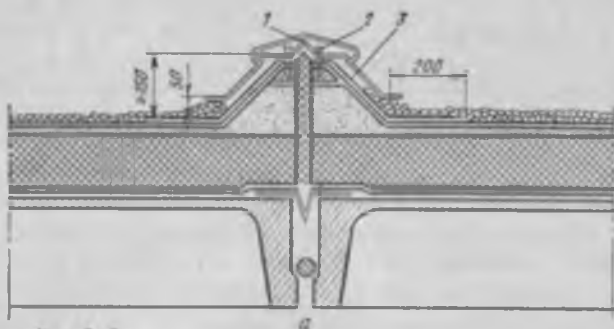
Конструкция деформационного шва в пределах покрытия и примыкания кровли к стене:
